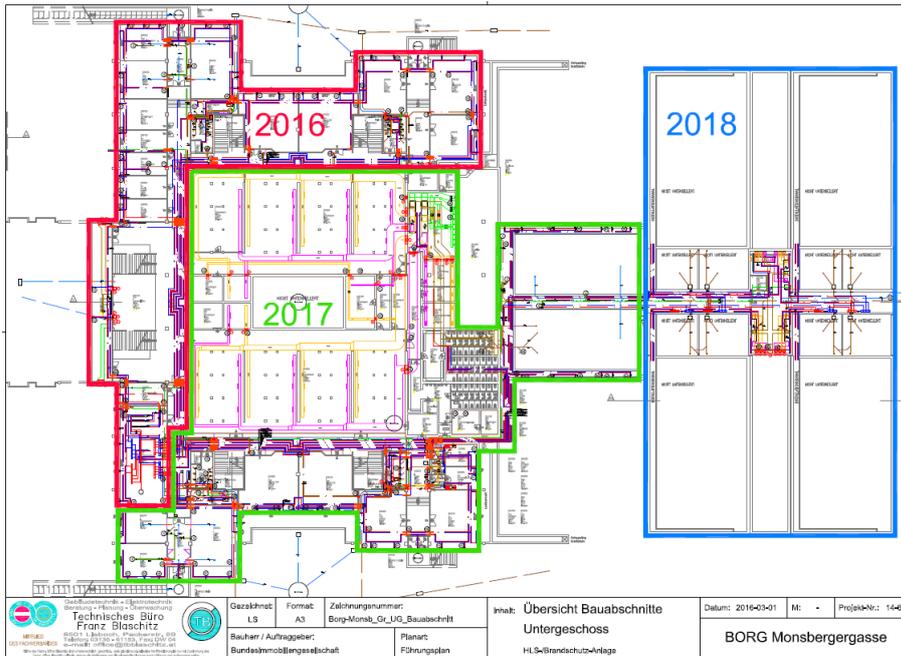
BORG - Führungsplan: Untergeschoss
